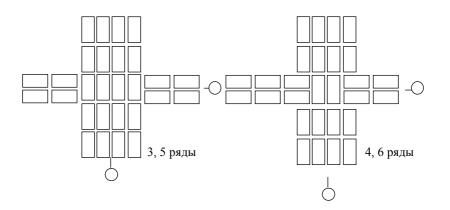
Кладка пересечений стен толщиной в 2 и 1 кирпич
